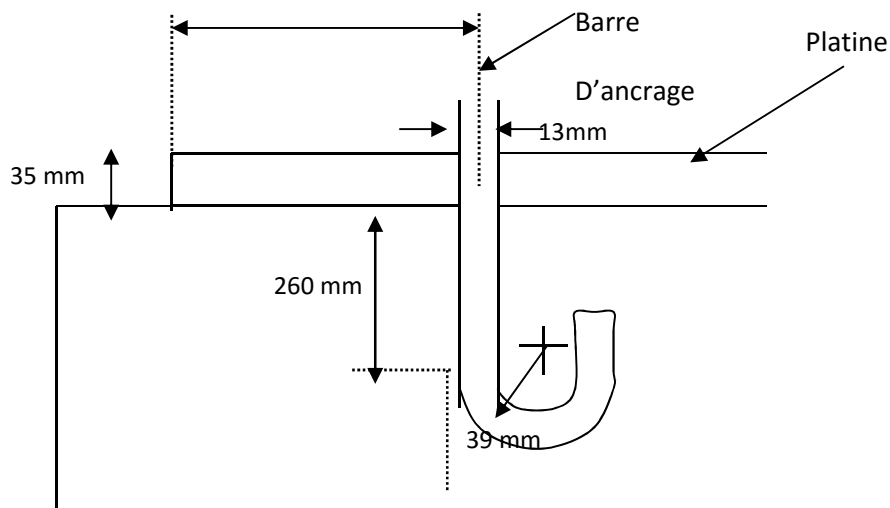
assemblage pied de poteaux avec tige d'ancrage
